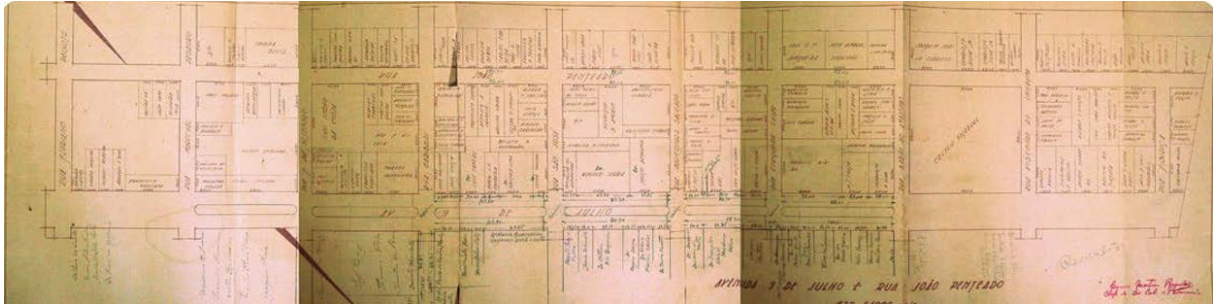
Planta de demarcação dos terrenos desapropriados para a construção da Avenida Nove de Julho.
